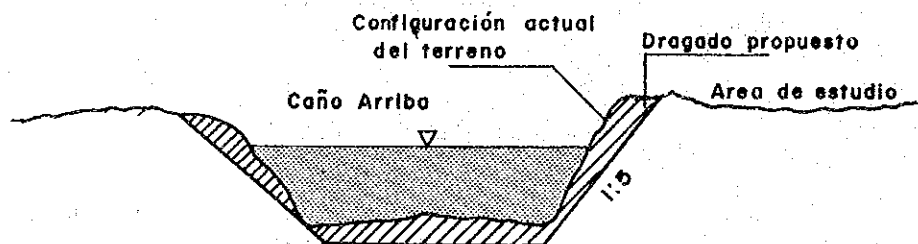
SECCION TIPICA DEL CAÑO ARRIBA
